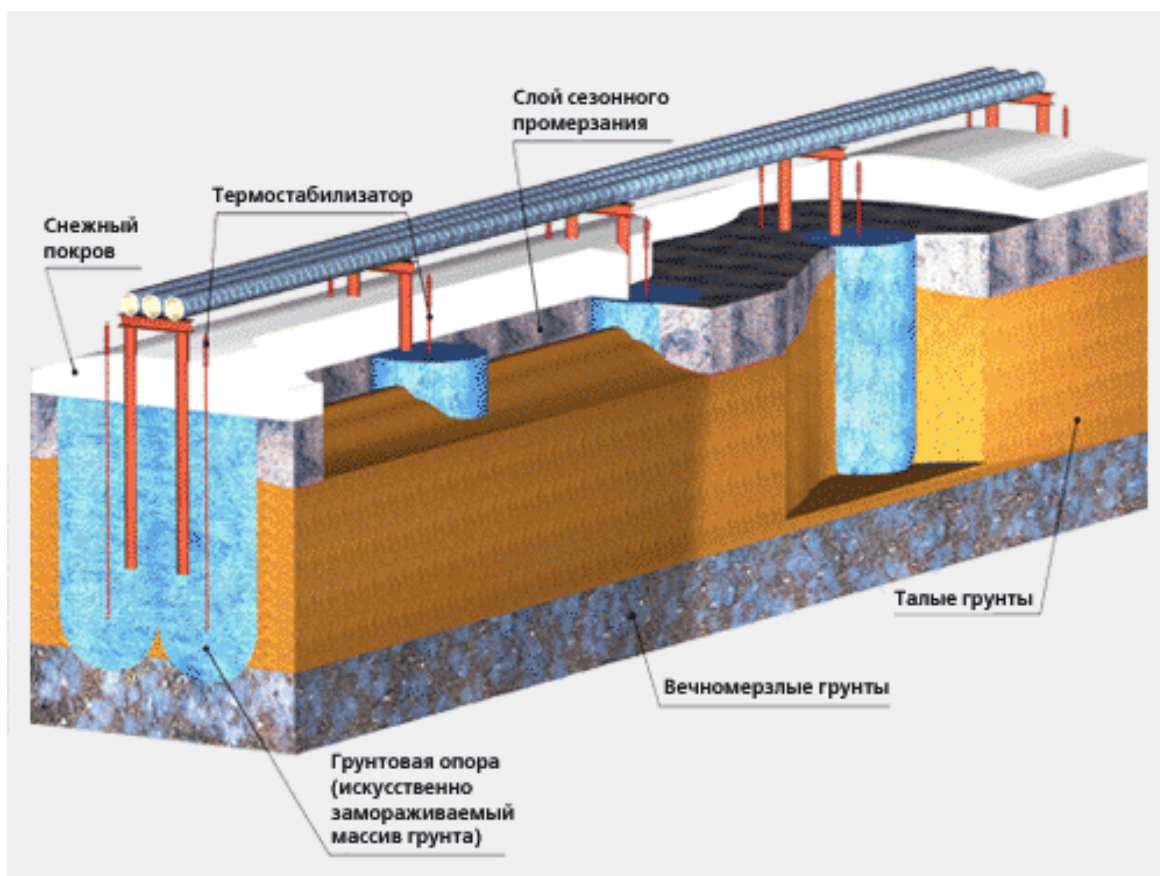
Усиление опор газопроводов надземной прокладки в районе распространения вечномерзлых грунтов путем искусственного замораживания грунтов в основании
